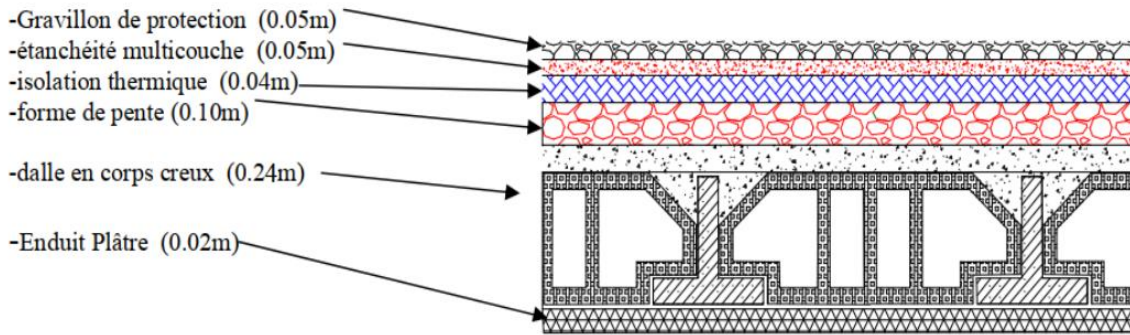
Schéma d'un plancher - terrasse inaccessible.
